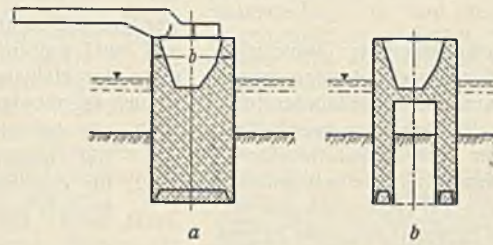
u. b. Klappenpfeiler mit gewöhnlichem und mit Ringsenkkasten.
